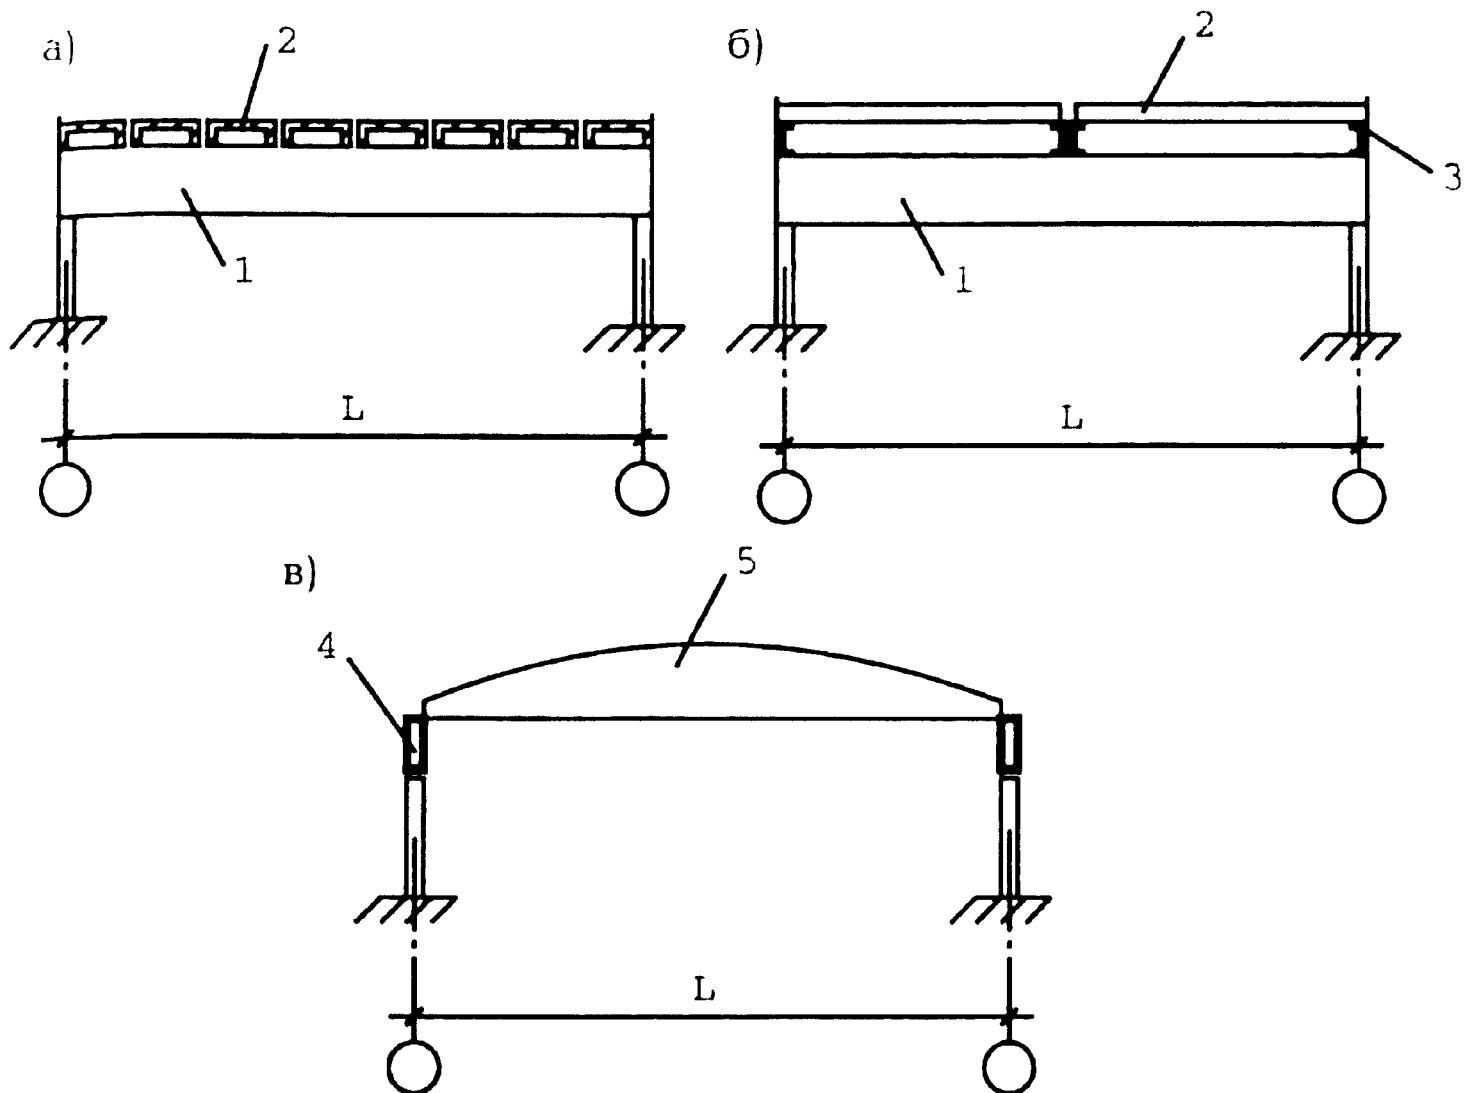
Схемы устройства совмещенных (плоскостных) покрытий промышленных зданий: а - беспрогонная; б - прогонная; в - из длинномерных настилов; 1 - стропильная балка; 2 - панель перекрытия; 3 - прогон; 4 - ригель; 5 - длинномерный настил
